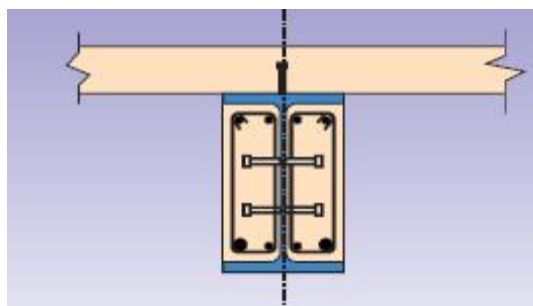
La présence des armatures dans la poutre mixte [15]
